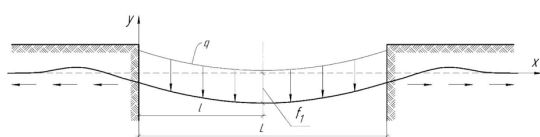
Расчетная схема однопролетного бескомпенсаторного балочного перехода
